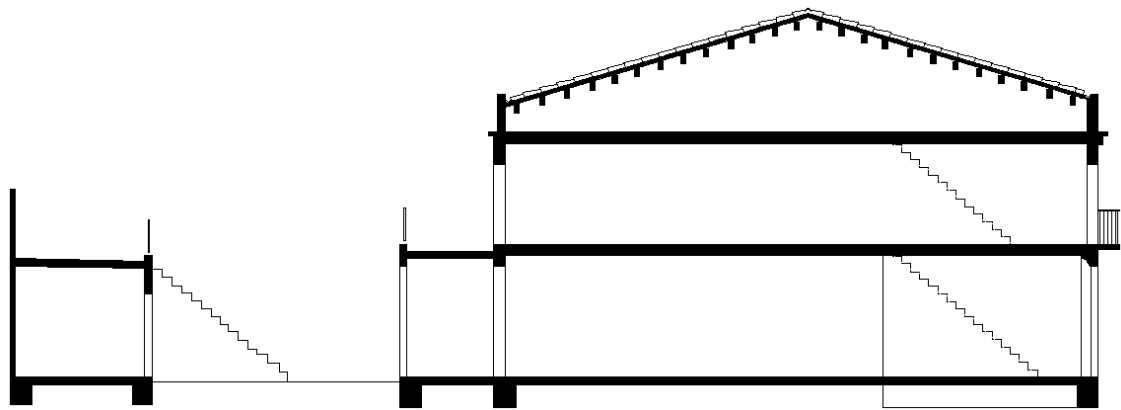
b Sección tipo casa artesana unifamiliar (planta piso y planta baja)
